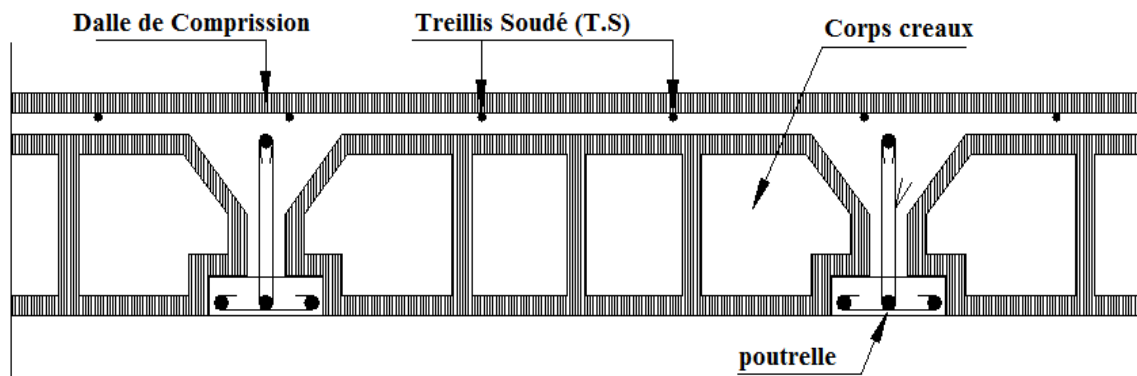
Coupe verticale d'un plancher en corps creux
